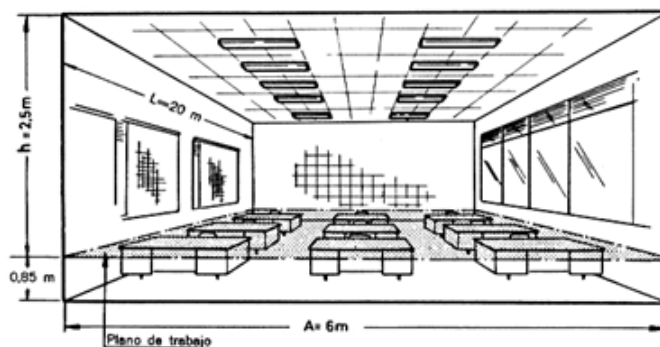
Plano de trabajo de una aula (Fuente: Ovidio E. Reyes)
